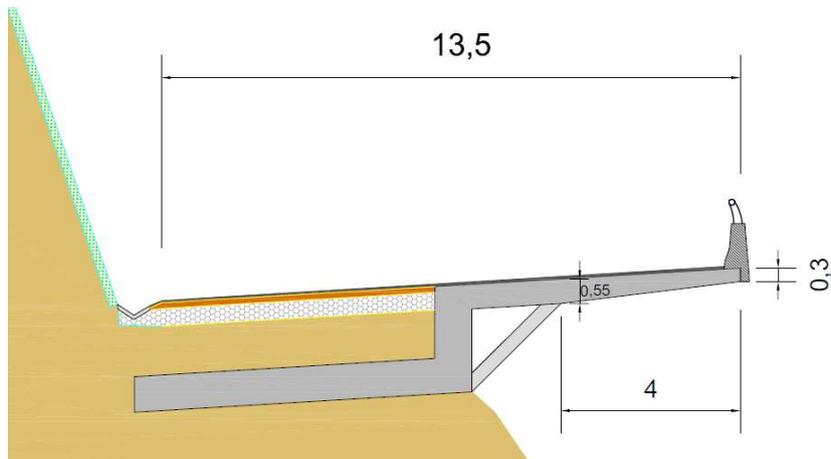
SECCIÓN CON VOLADIZO (COTAS EN METROS)
